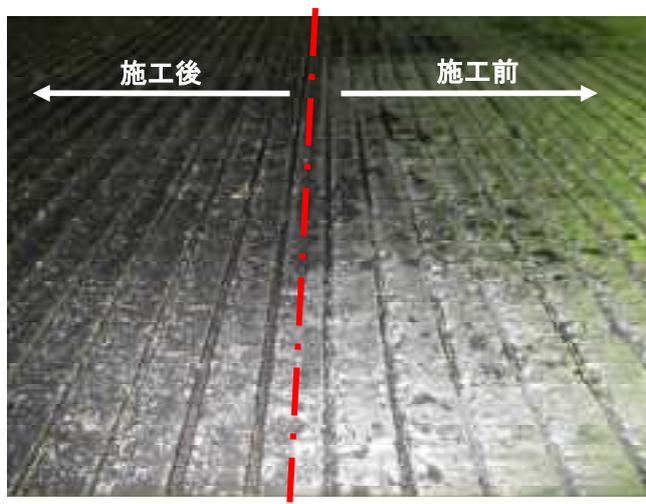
ゴム除去工 (施工前・施工後) の状況 (例)
